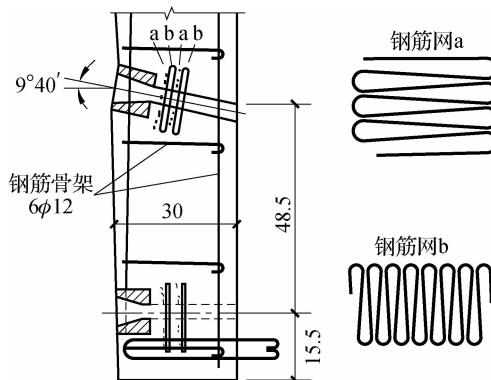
预应力梁端板和叉形钢筋网(尺寸单位:mm)
